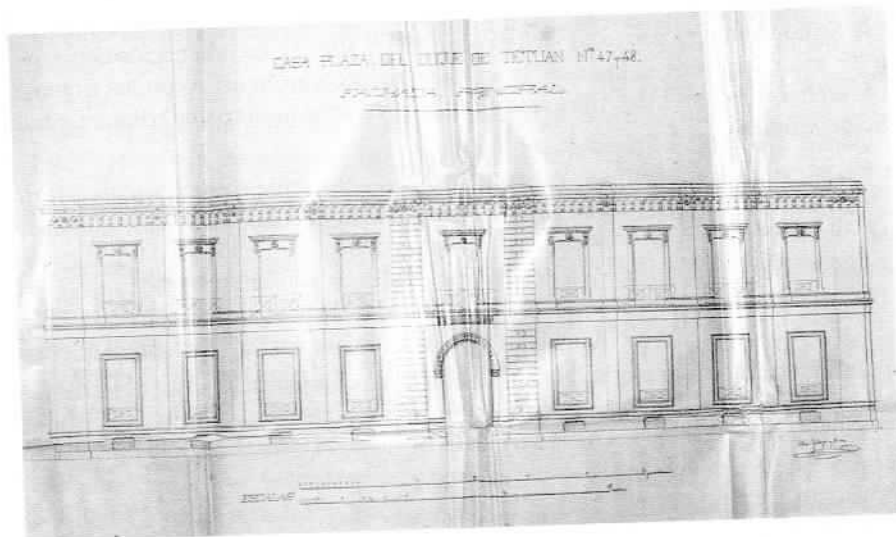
Proyecto de fachada en plaza Duque de Tetuán 47 y 48. Eliás Gallegos, 1873.
